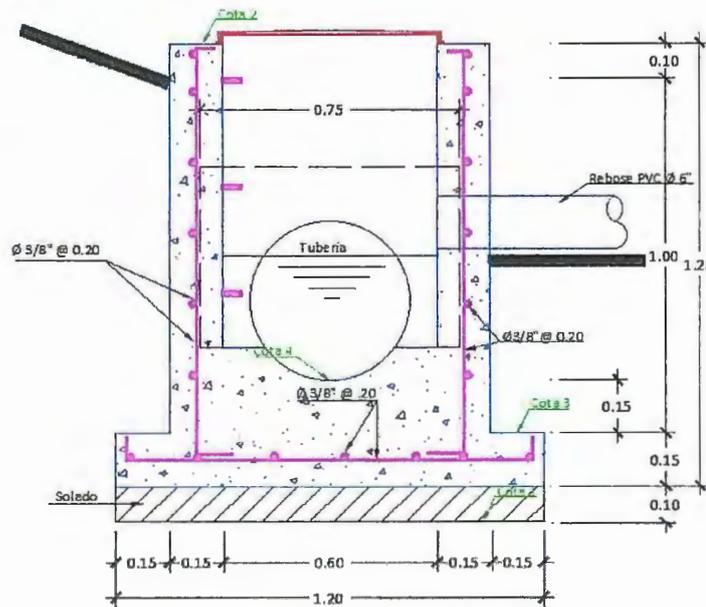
Sección Típica Longitudinal de la Cámara de Inspección
